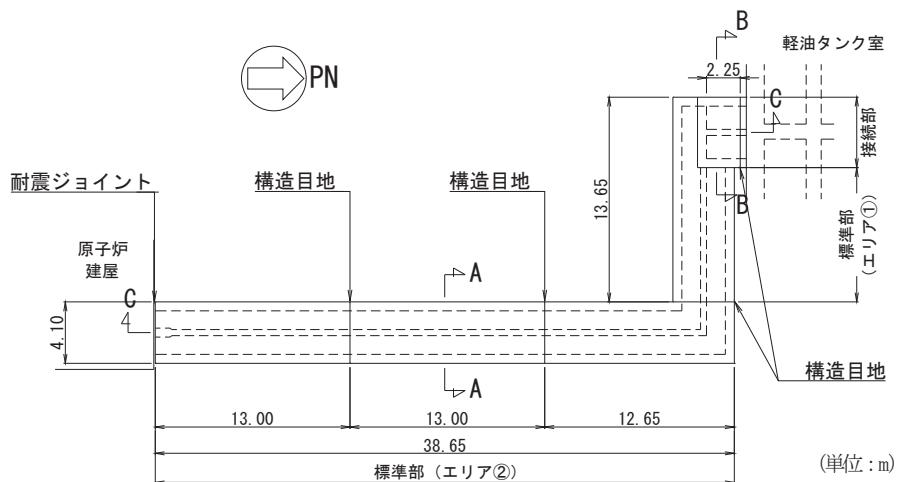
軽油タンク連絡ダクト平面図（詳細）
